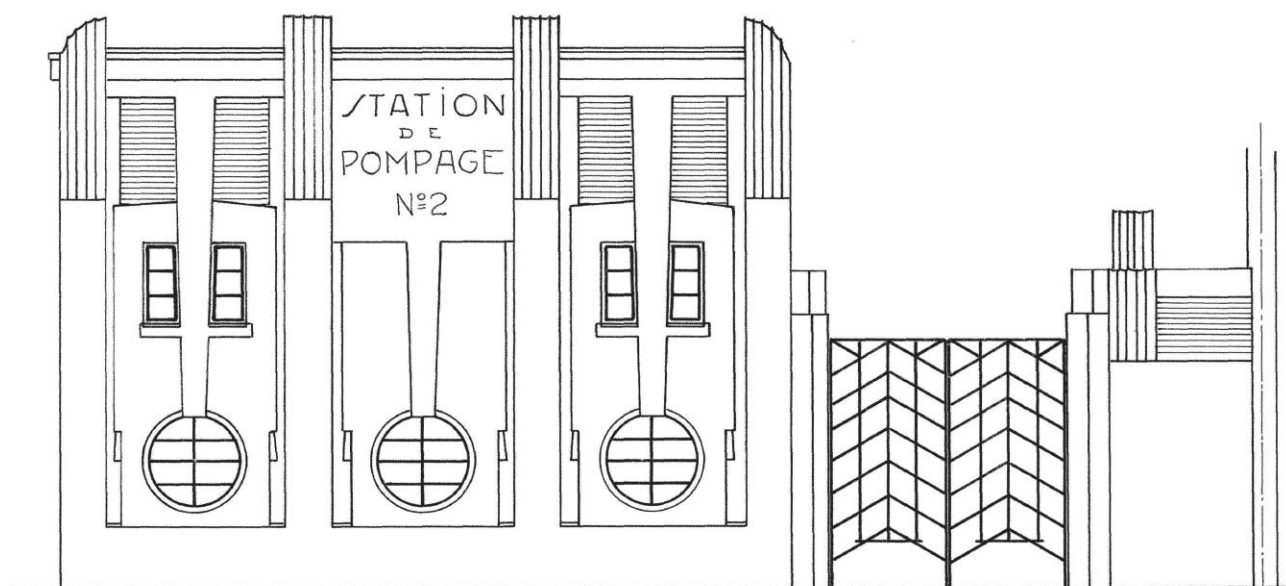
Elevation de la façade Sud du massif - deuxième cas
